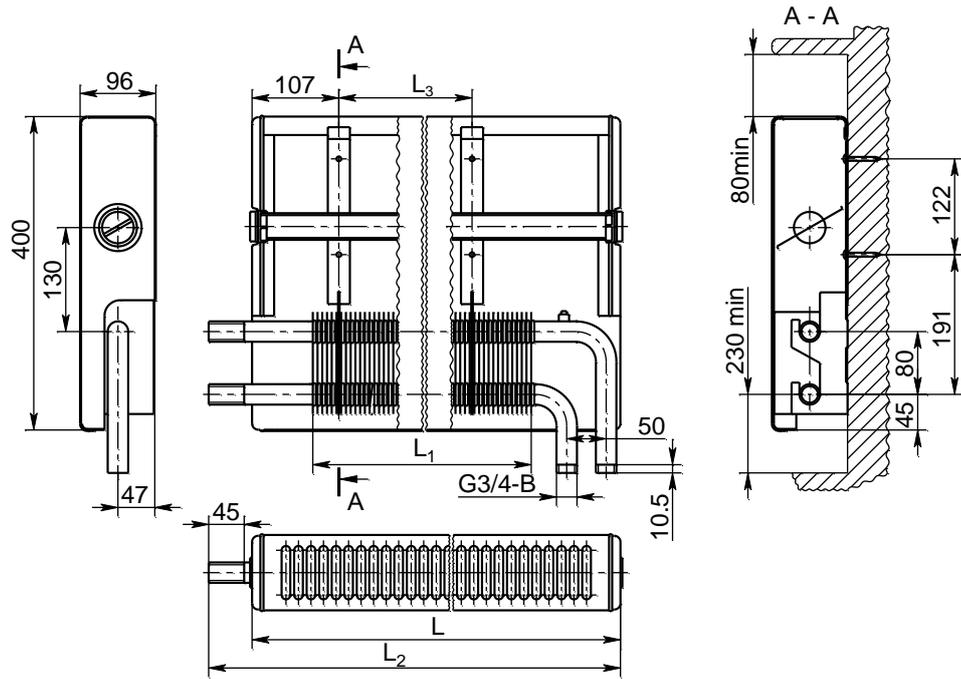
Конвектор «Универсал КНУ НП» малой глубины, с «воздушным» клапаном, проходной, с нижними присоединительными патрубками (табл. 1.7)
